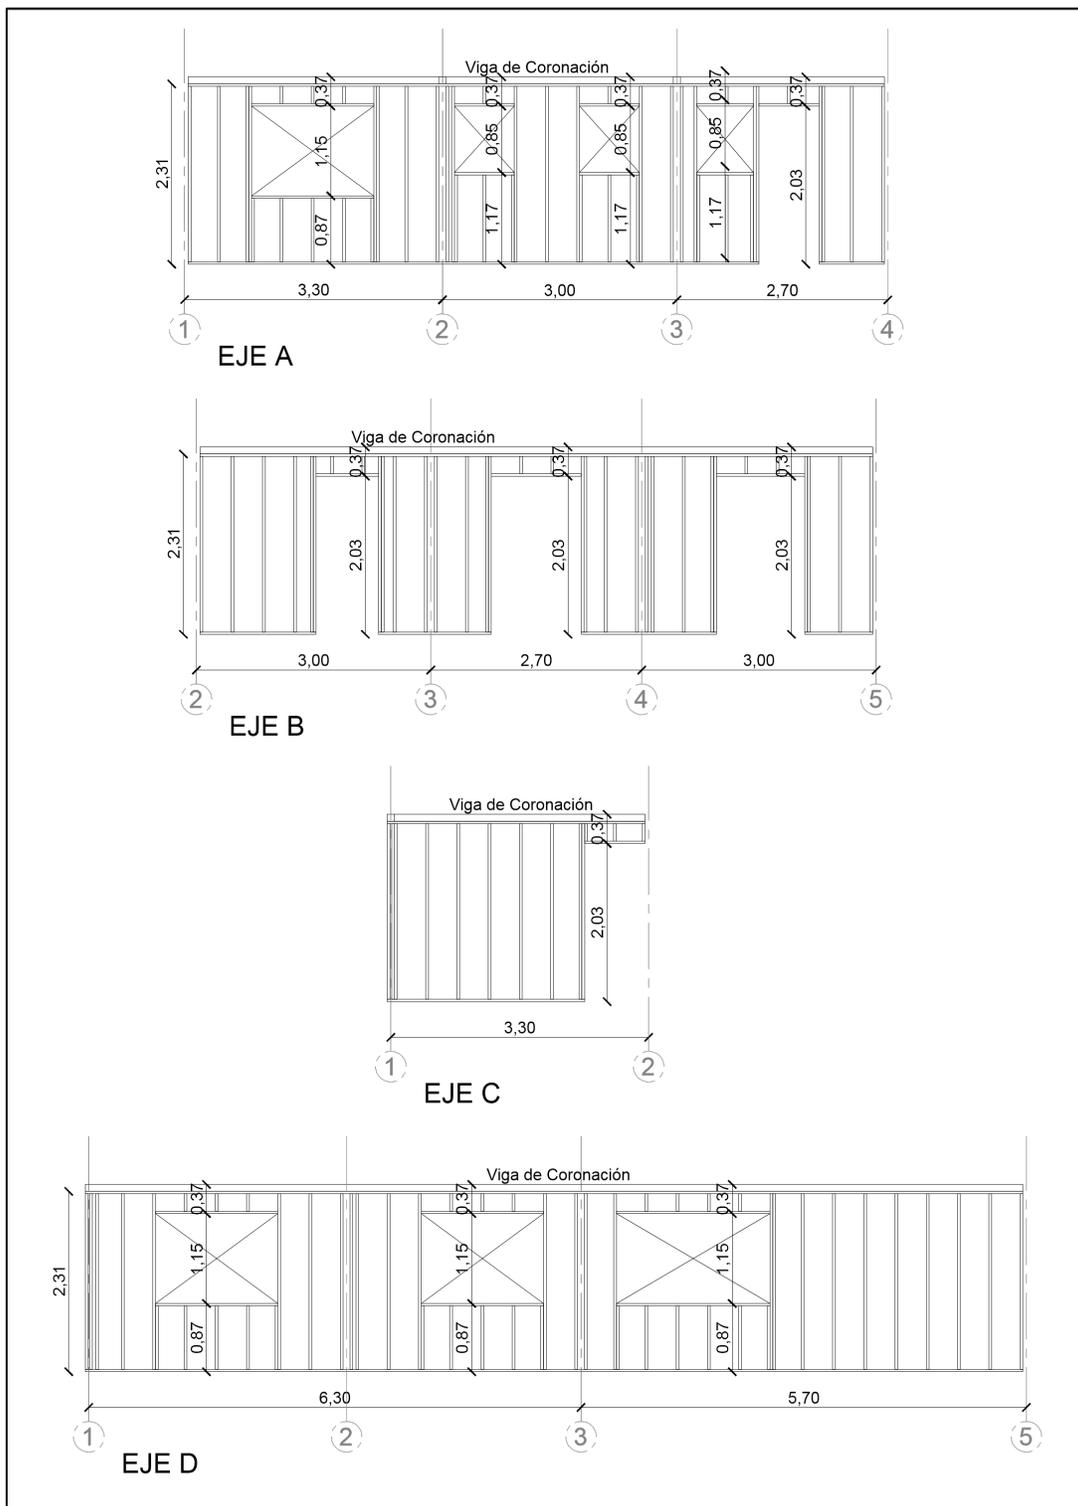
Elevaciones de estructuras modelo acero galvanizado
